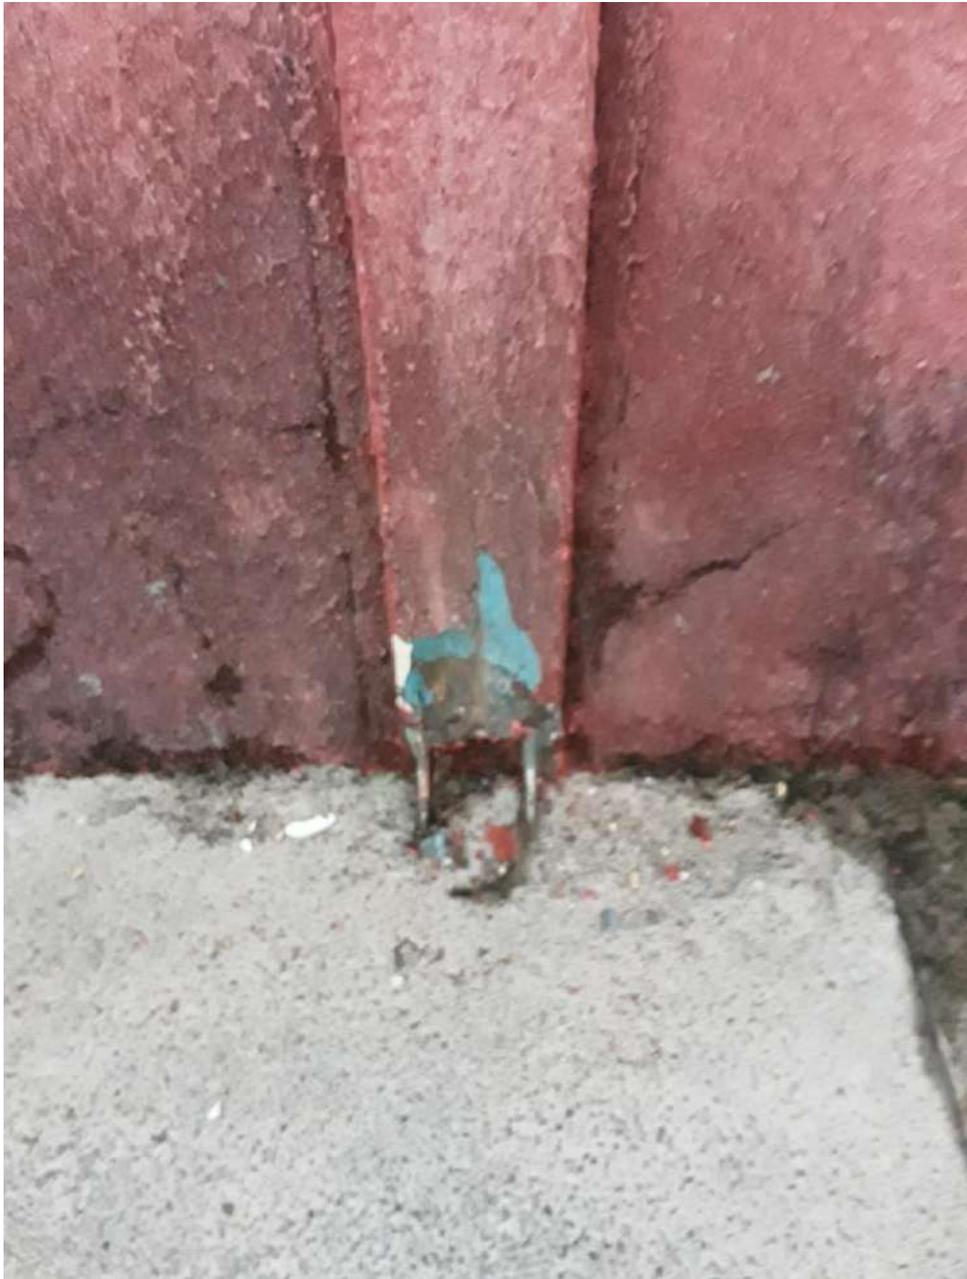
Base do Pilar 17 corrosão grau B
